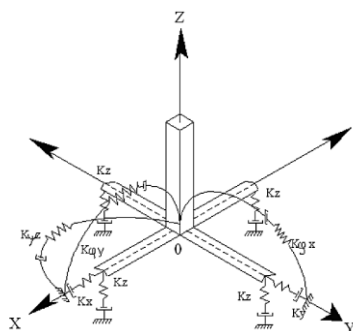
Esquema espacial de cálculo de la cimentación tipo zapata aislada
